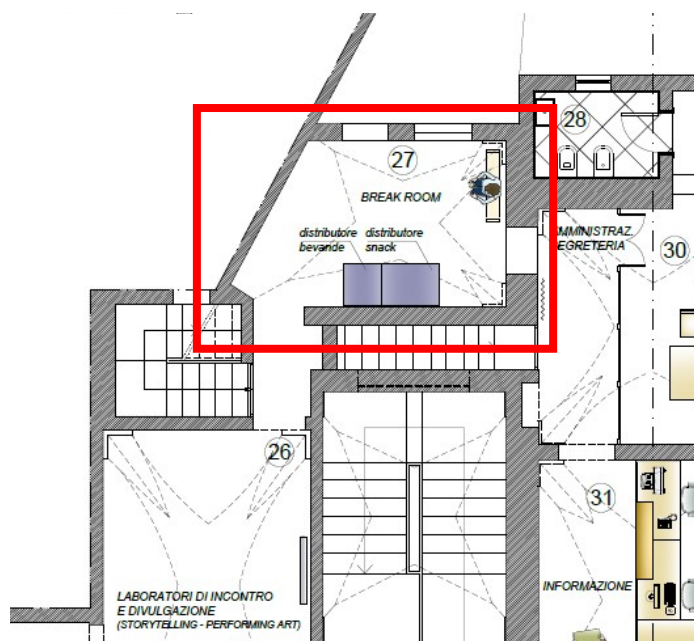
Stralcio della planimetria del piano primo con individuazione della sala 27 (in rosso)
